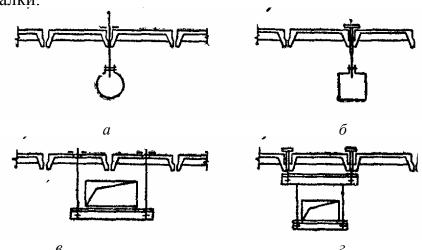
Крепление горизонтальных воздуховодов к перекрытию
